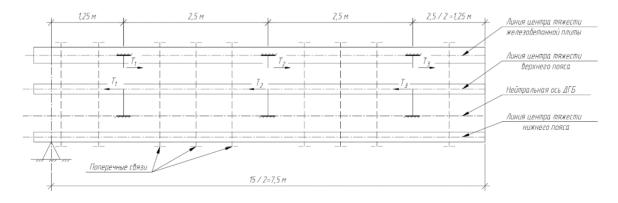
Основная система композитного пролётного строения из дощато-нагельно-гвоздевых блоков и железобетонной плиты
